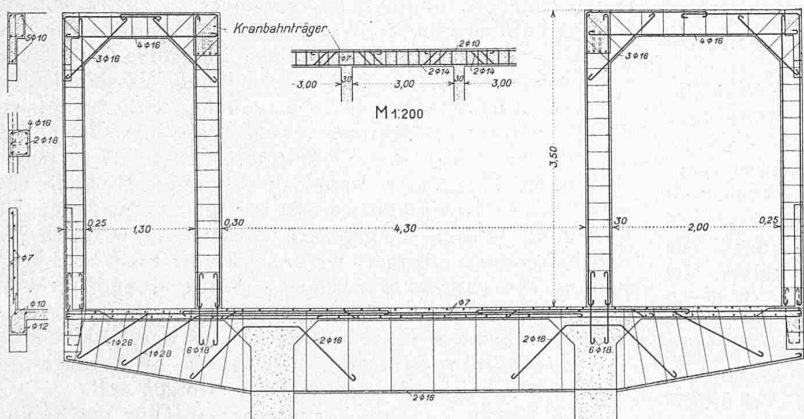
Eisenbeton-Konstruktion des Dienststeges. — Querschnitt 1:80.
